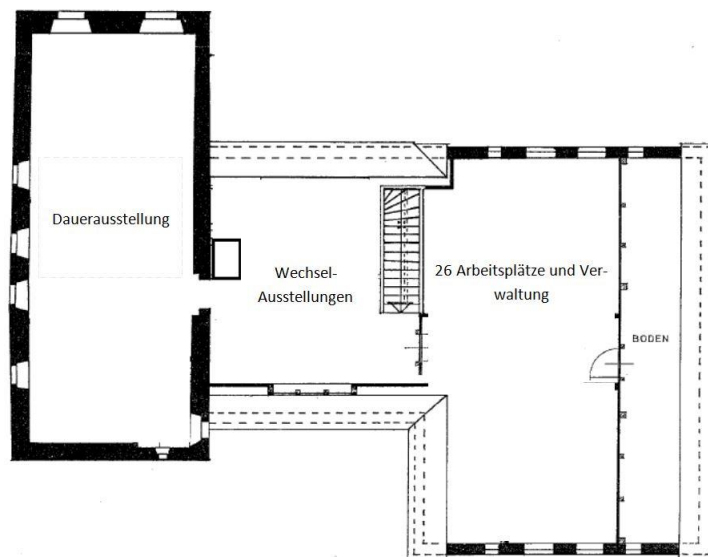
; Grundriss des Gebäudes im OG
